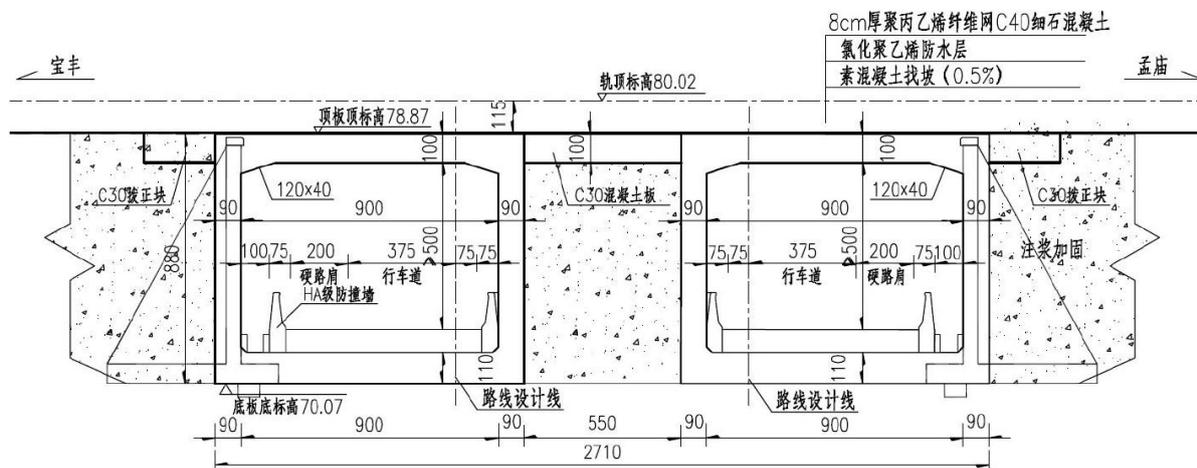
分离式钢筋混凝土框架桥横断面示意图
